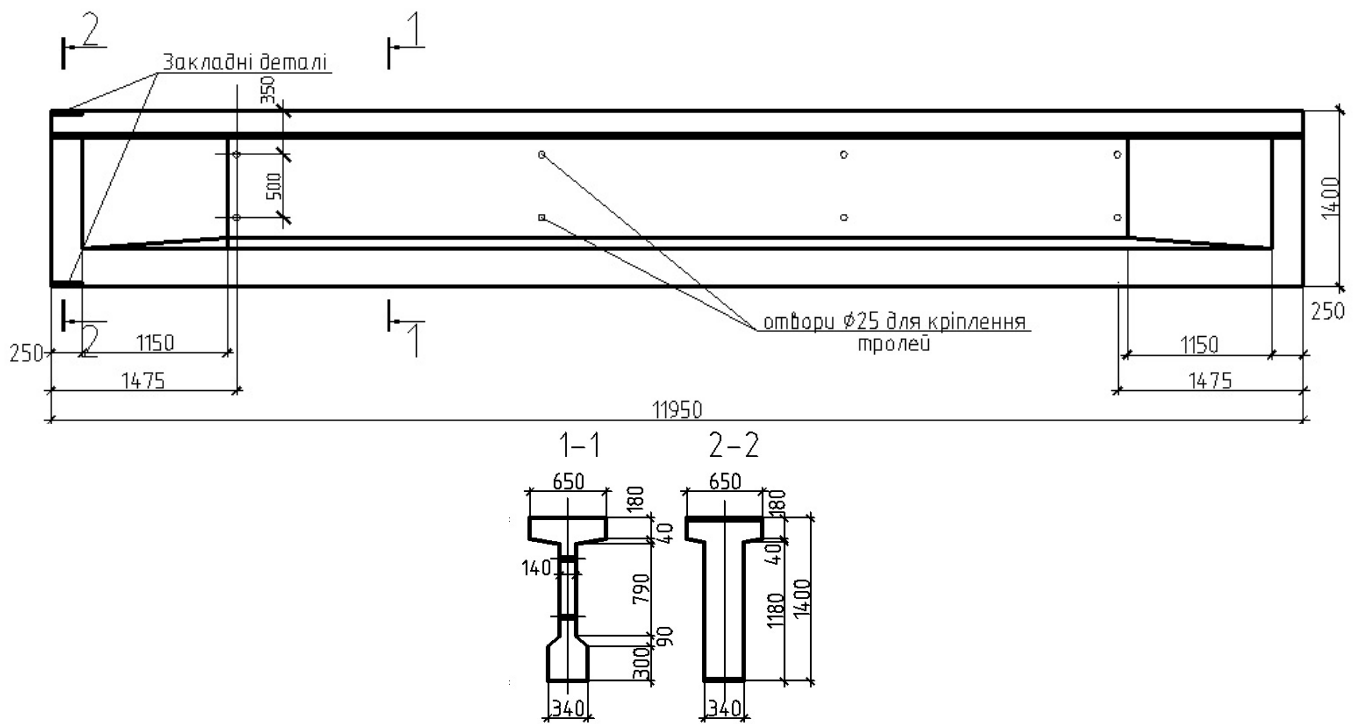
Опалубка підкранової балки прольотом 12 м
